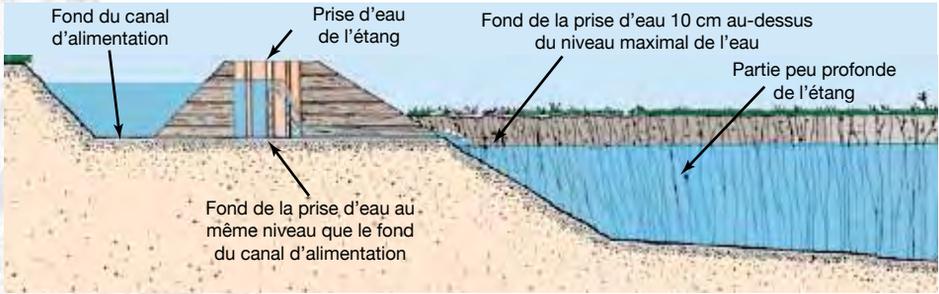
Coupe transversale de la prise d'eau d'un étang.
